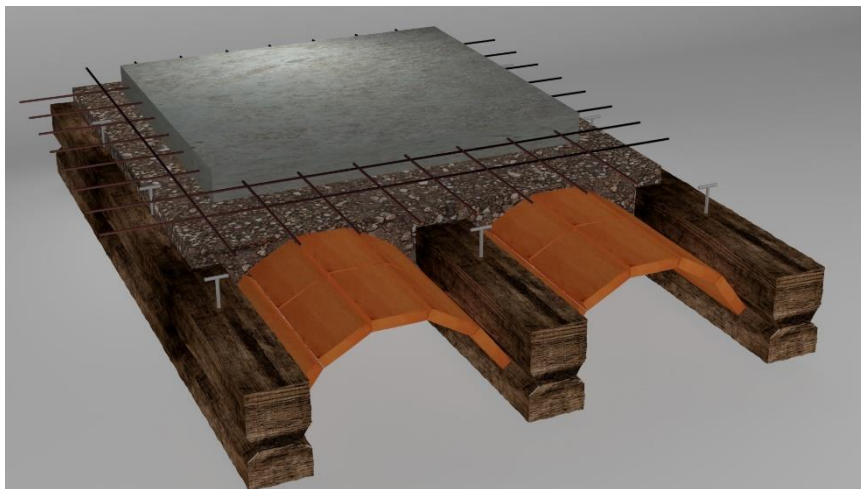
3D Forjado revoltón mixto terminado. 2015. Fuente propia.
